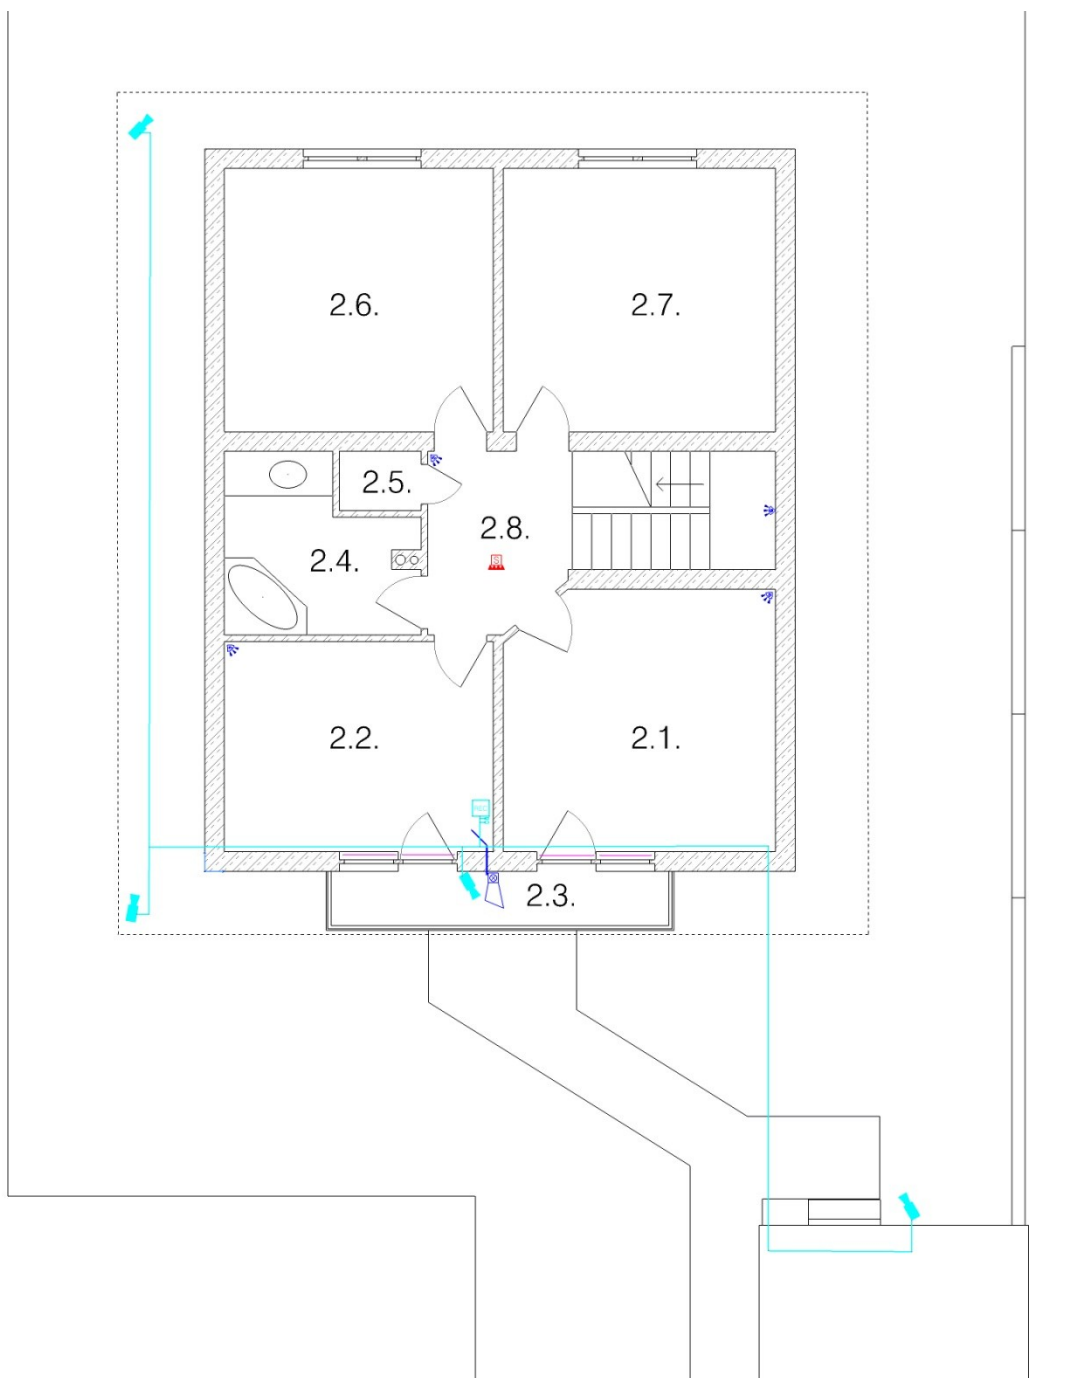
Půdorysný plán prvního nadzemního podlaží
